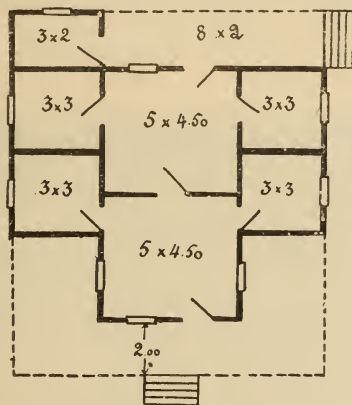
Plan du pavillon démontable représenté figure 14.
